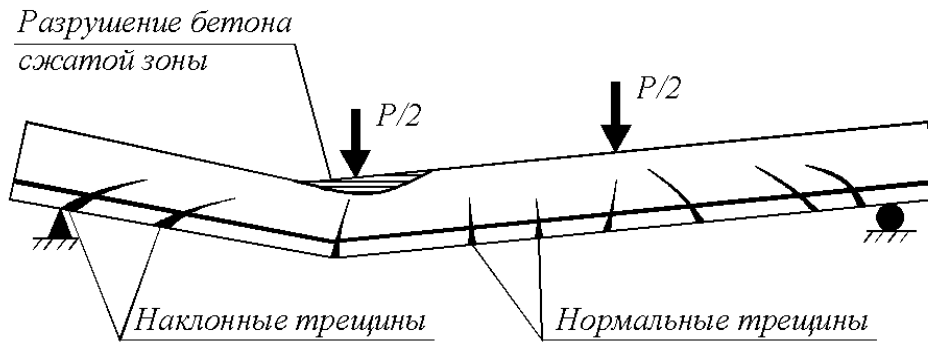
Характер разрушения железобетонной балки по нормальному сечению при изгибе
